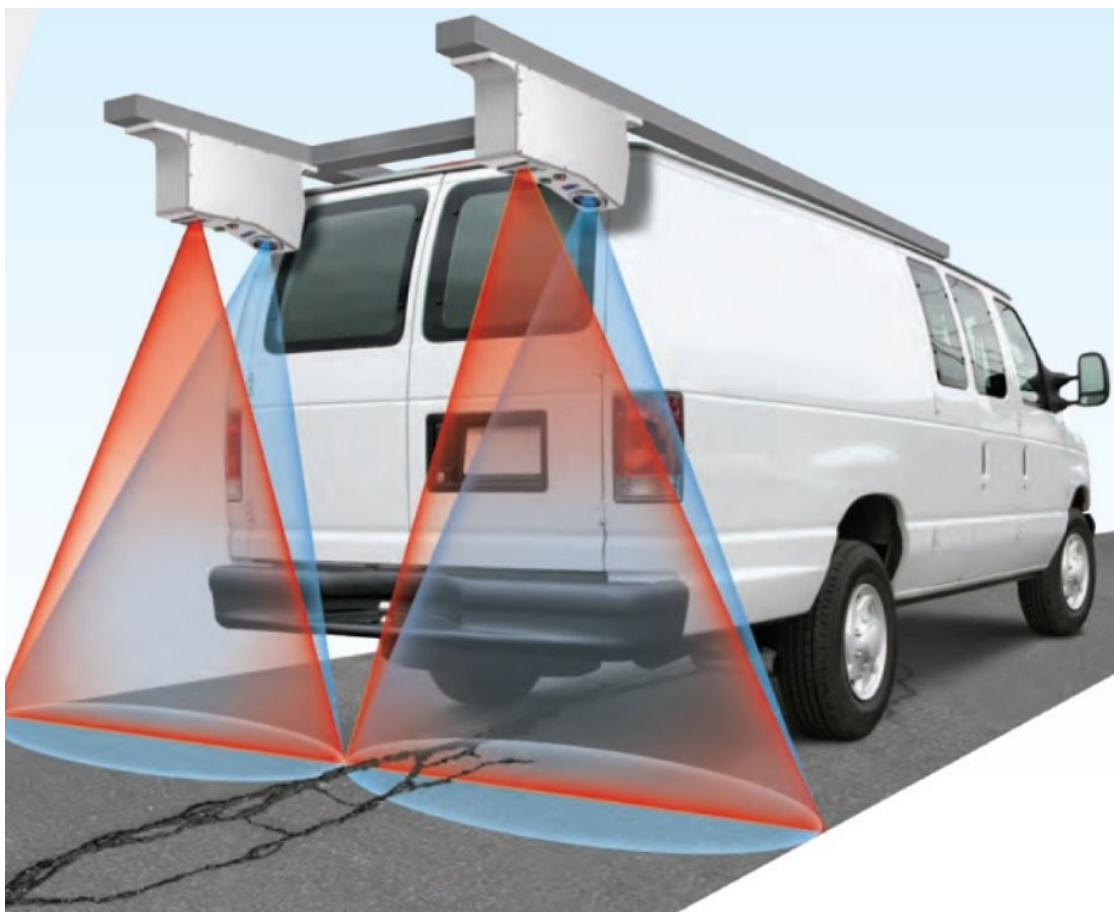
Escâner de pavimento embarcado em veículo utilitário.
